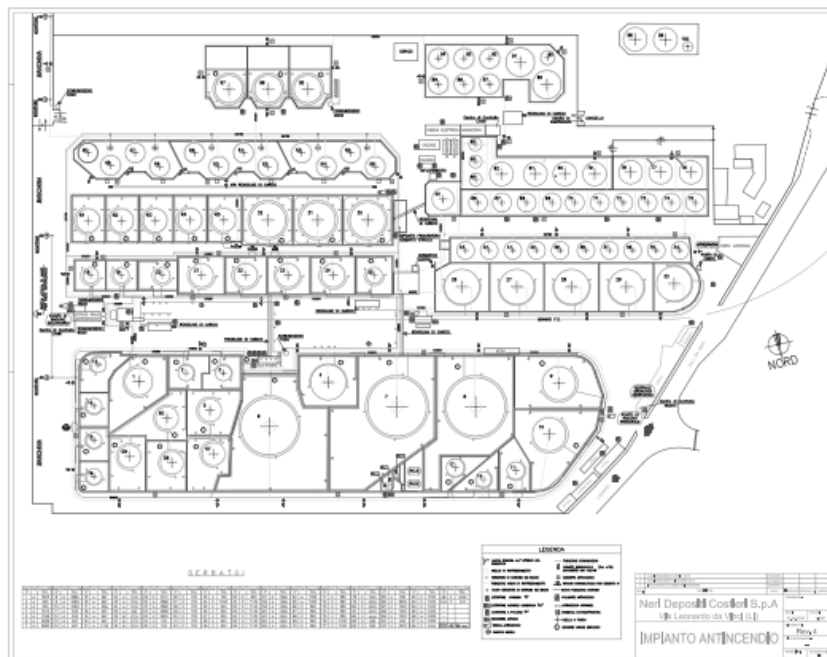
Planimetria di stabilimento tratta dal RdS 2016
